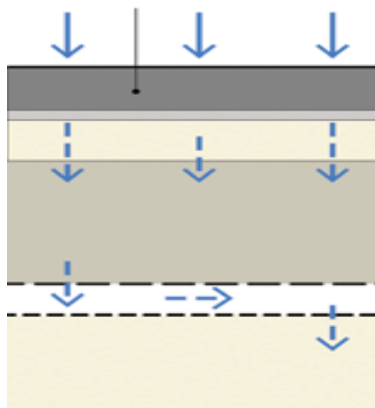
Sistema de pavimento asfáltico poroso Tipo B (CIRIA, 2015).
